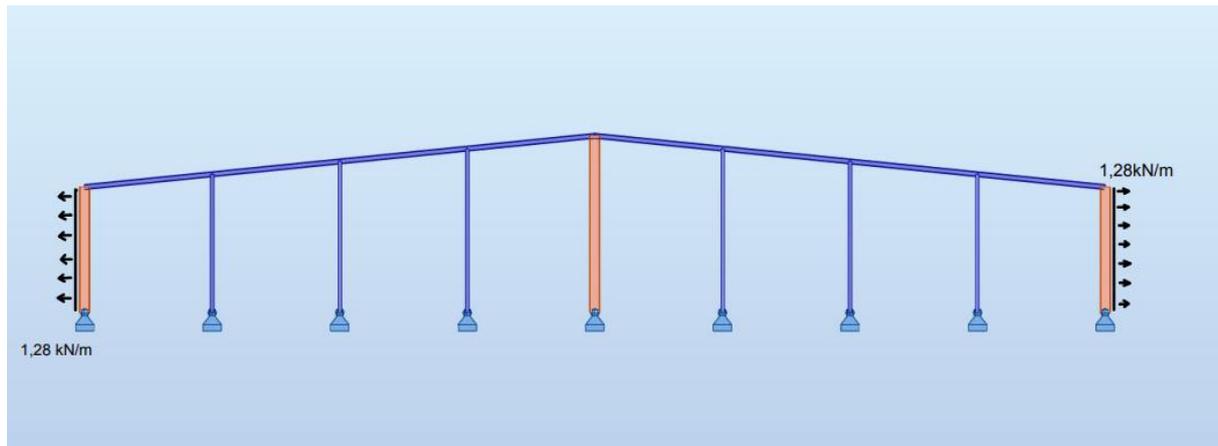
REPRESENTACIÓN CARGAS DE VIENTO EN ZONA C EN PÓRTICO DE FACHADA (PLANO PARALELO AL PÓRTICO) CON DIRECCIÓN LONGITUDINAL A LA FACHADA
